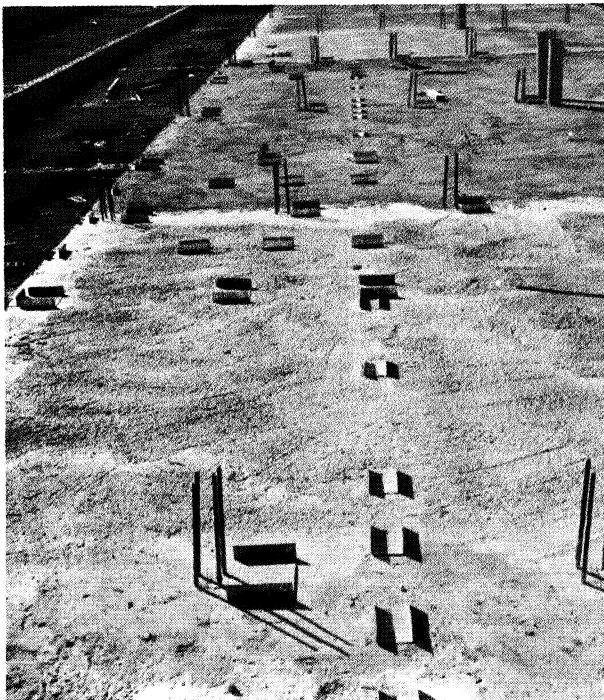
Replanteo de elementos de fijación sobre forjado.
